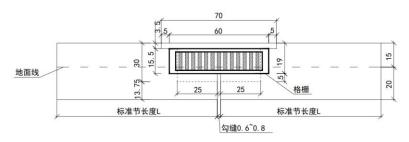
15×35 石质立缘石立面图 (单位: cm)
